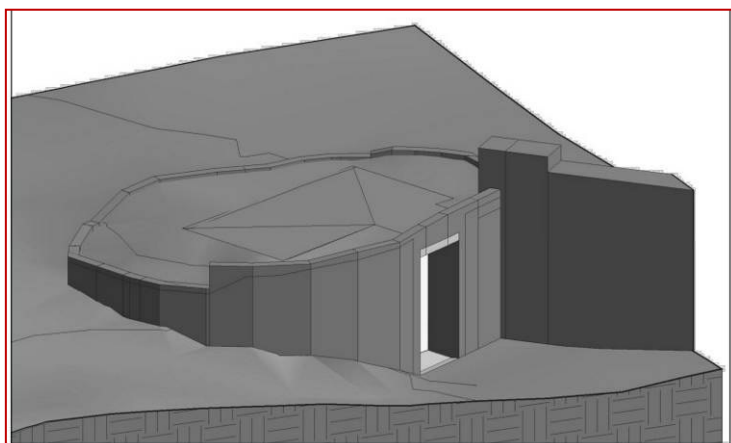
Estratto TAV. 02 di progetto - Sezione A-A
